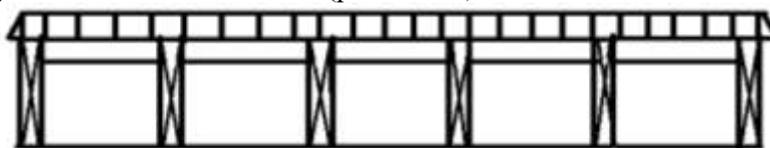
Метало-конструкционное соединение стен и крыши
